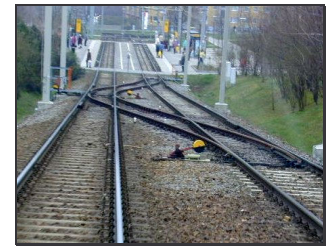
Straßenbahnhaltestelle im ebenen, angeschütteten Bereich einer Steigungsstrecke
